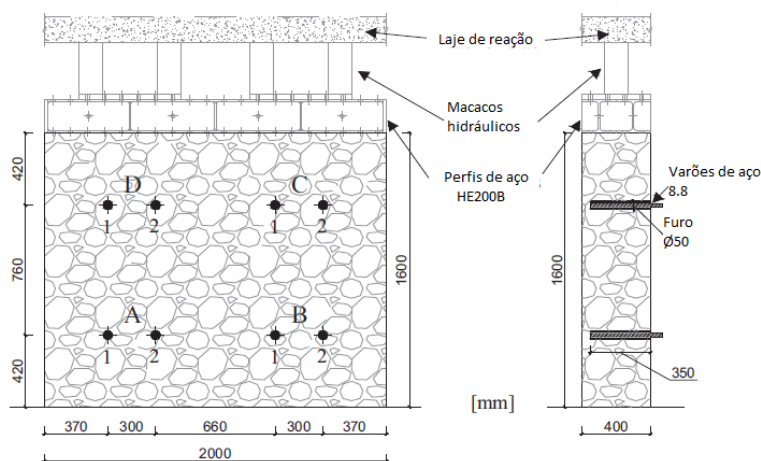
Posicionamento das pregagens e do murete no sistema de ensaio [26]
